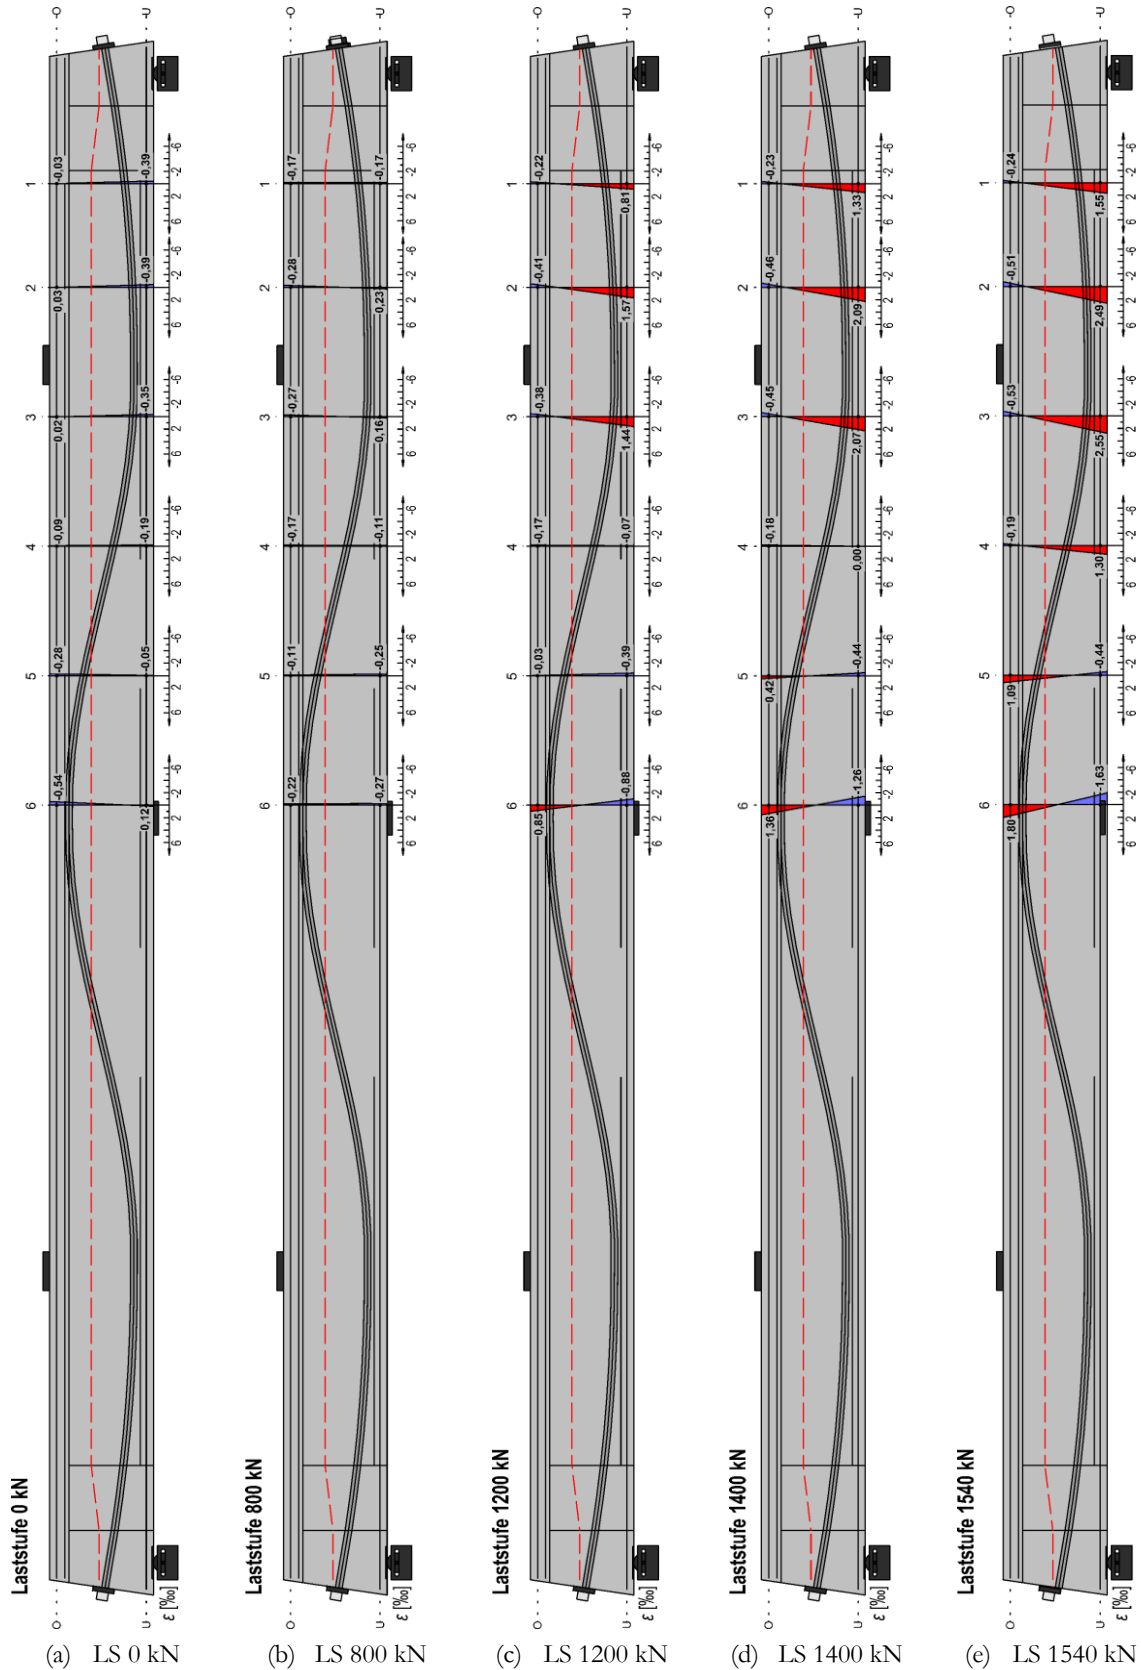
Dehnungen der Längsbewehrung des Versuchsträgers DLT 1 für ausgewählte Laststufen, Teil 1
